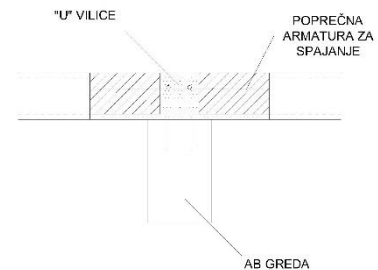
Stropna konstrukcija od šupljih betonskih ploča - sistem PGM-Hotic
